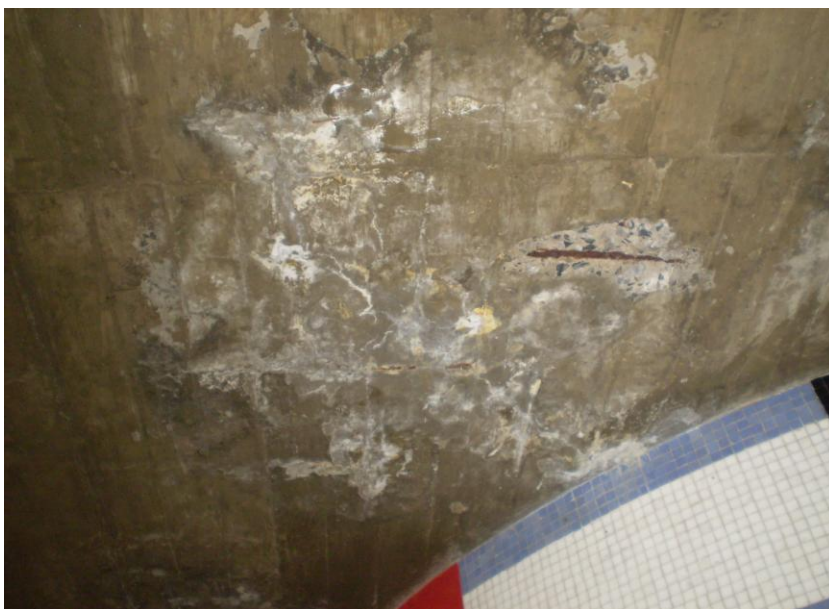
Eflorescencias y pérdida de recubrimiento en la losa de techo
